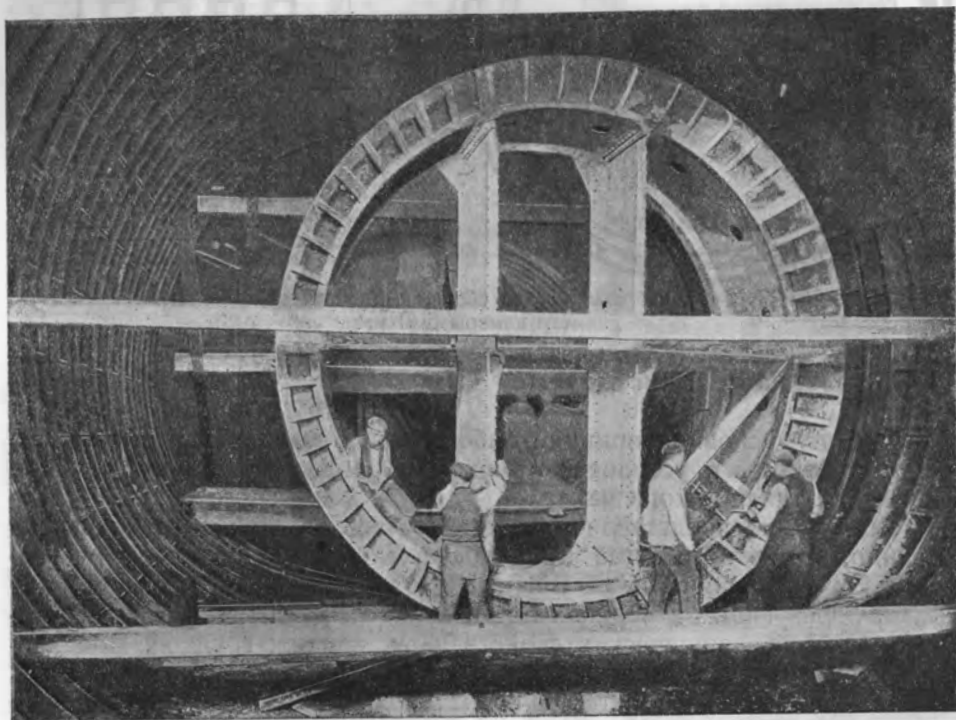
Монтаж конструкции перегонного щита в закрепленной тубингами щитовой камере.
